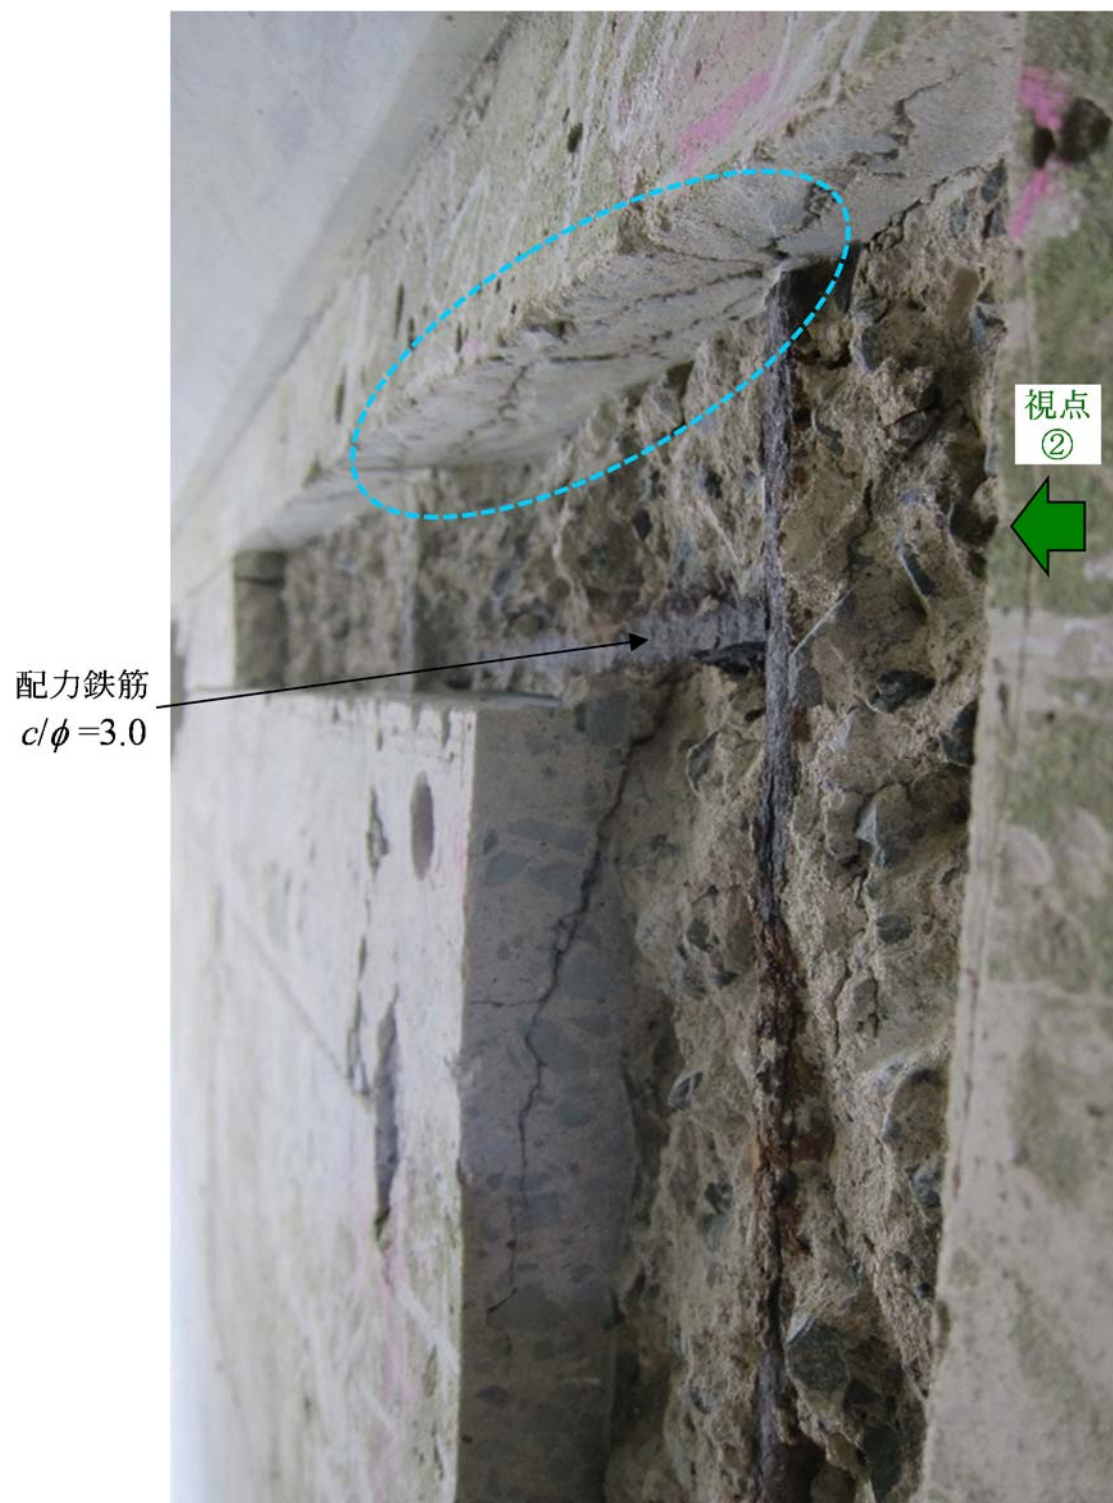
c/ϕ とひび割れ状況(視点②)
